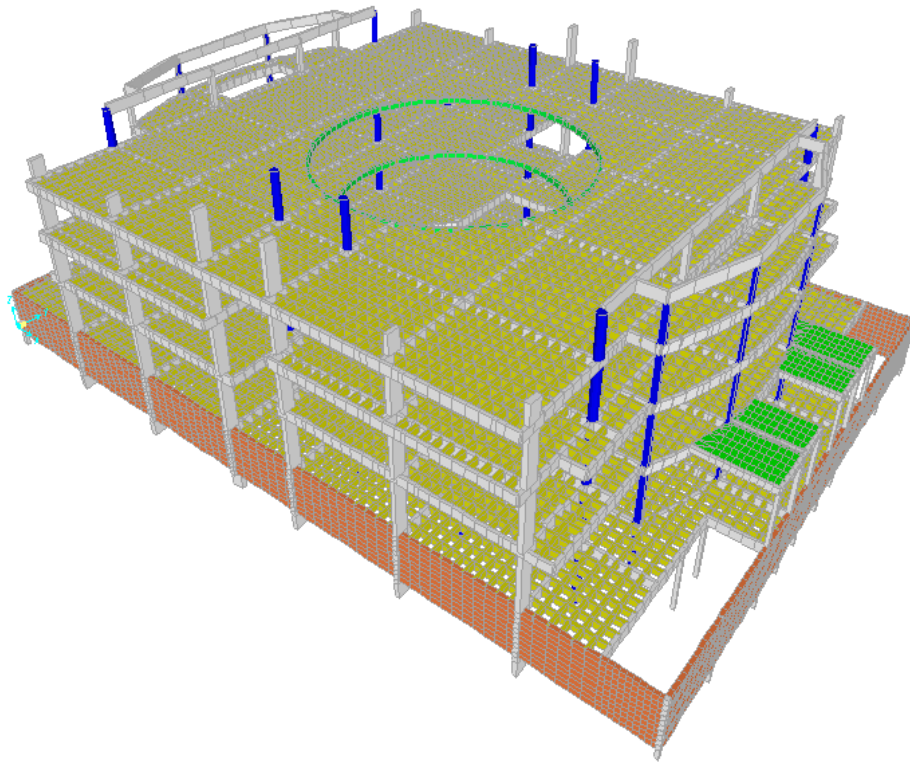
Modelado de estructura con vigas peraltadas mediante el método del emparrillado espacial de vigas
